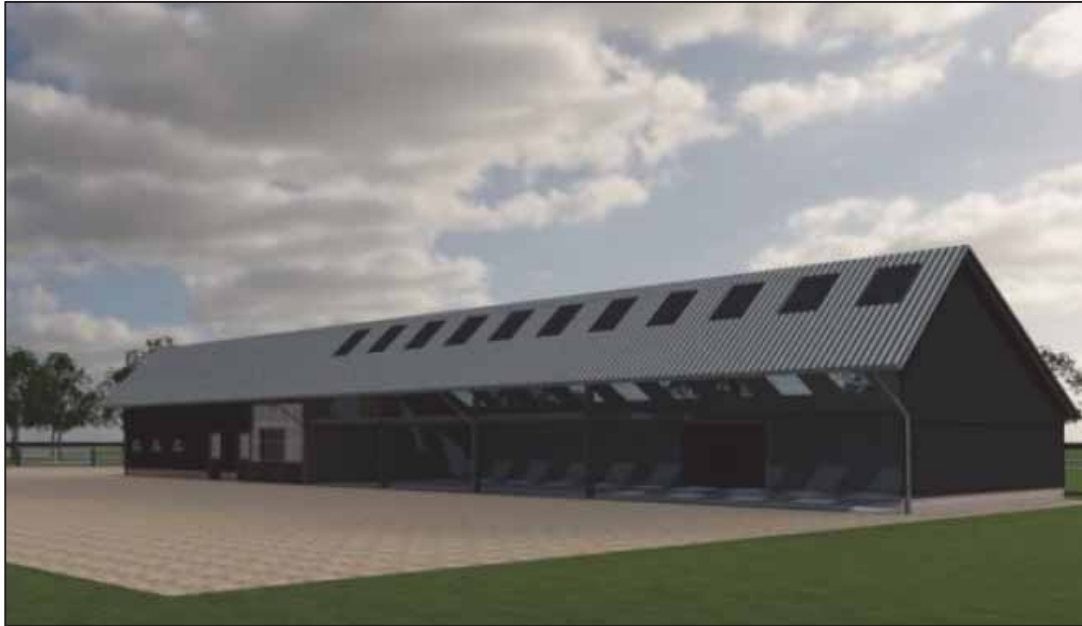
Aangezicht beoogde ontwikkeling fase 1 + fase 3 Nieuwe Steeg 1.
